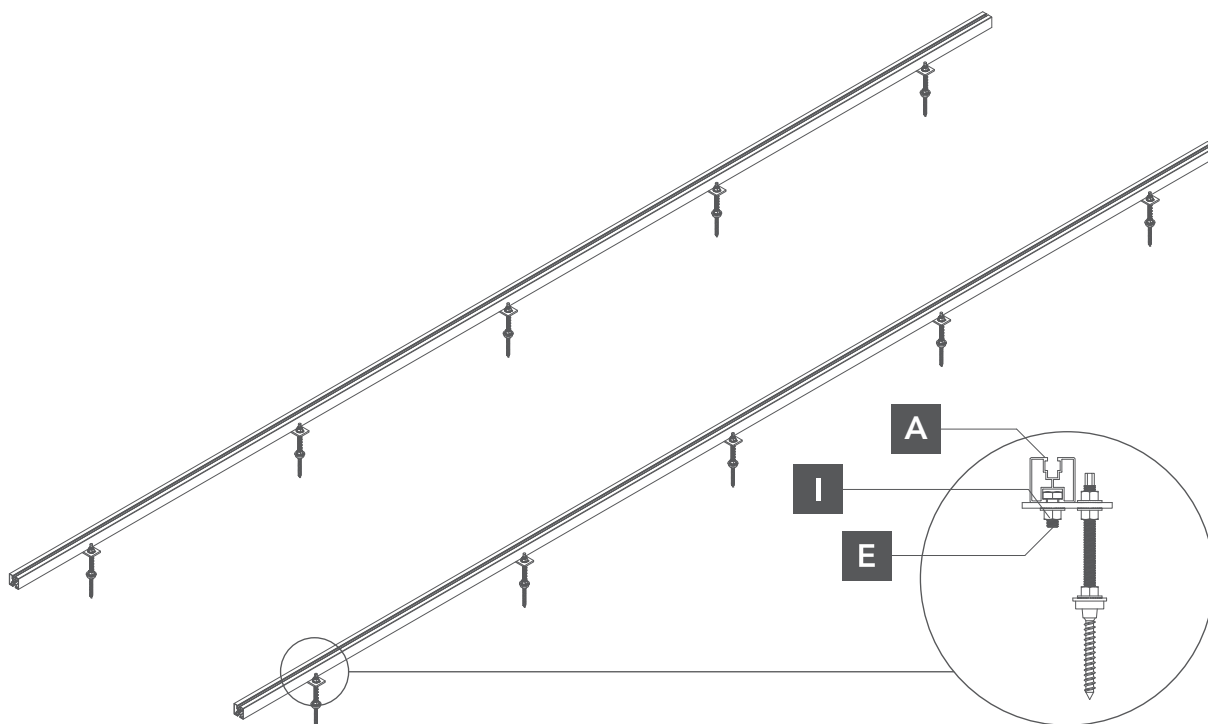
Befestigung der Montageschiene an dem Montageadapter
